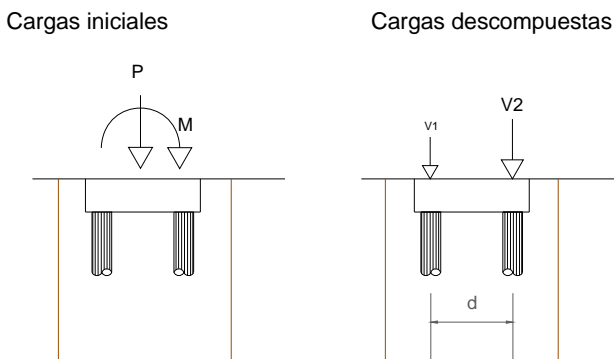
Cargas iniciales grupo de dos pilotes y cargas descompuestas para cálculo.
